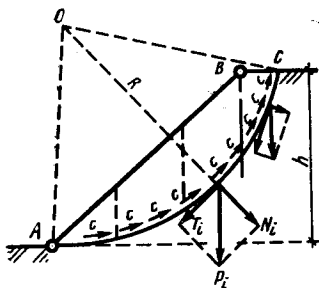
Определение устойчивости откоса методом круглоцилиндрической поверхности
